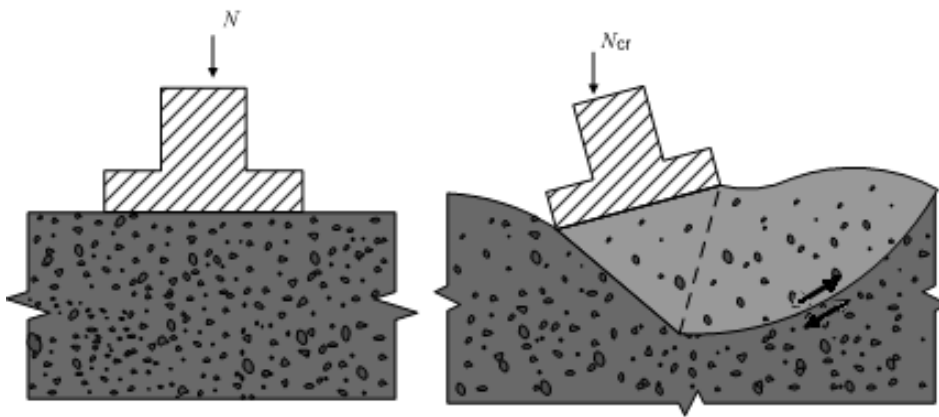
Схема потери устойчивости грунтового основания фундамента
